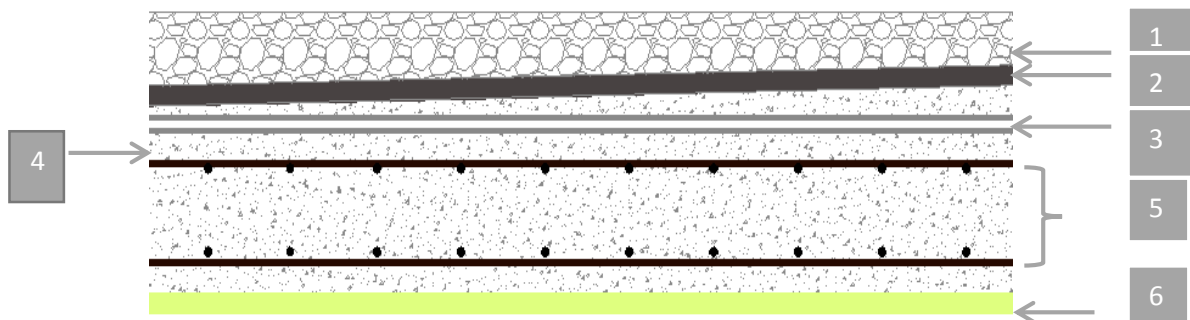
Composants d'un plancher terrasse en dalle pleine
